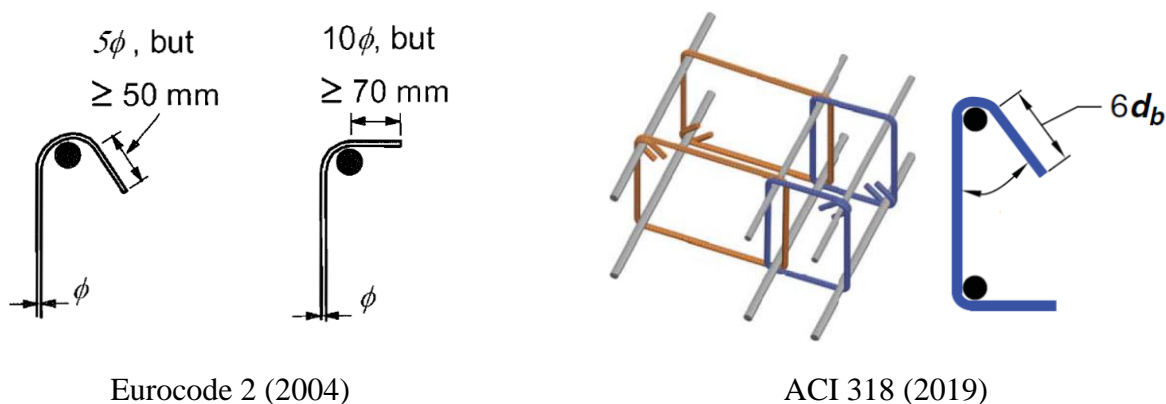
Detalhamento da ancoragem dos estribos segundo as normas
